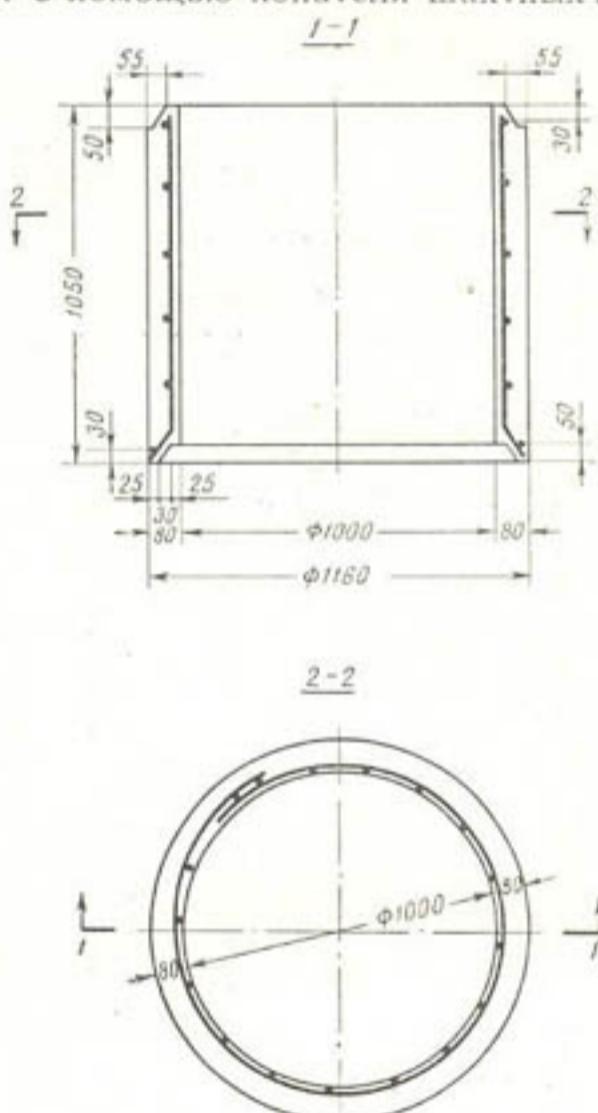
Железобетонное кольцо К-1 для шахтных колодцев.
